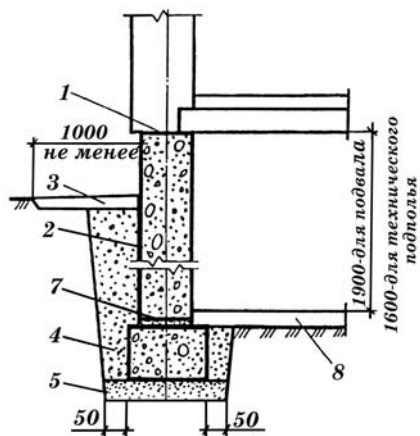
Вариант конструкции основания малоэтажного дома с подвалом: 1 – гидроизоляция из двух слоев рубероида на битумной мастике; 2 – обмазка горячим битумом за 2 раза; 3 – отмошка; 4 – обратная засыпка; 5 – песчаная подушка; 6 – утрамбованный грунт с щебнем; 7 – гидроизоляция из цементно-песчаного раствора М100 (состава 1:2); 8 – пол подвала или уплотненный грунт для технического подполья.
